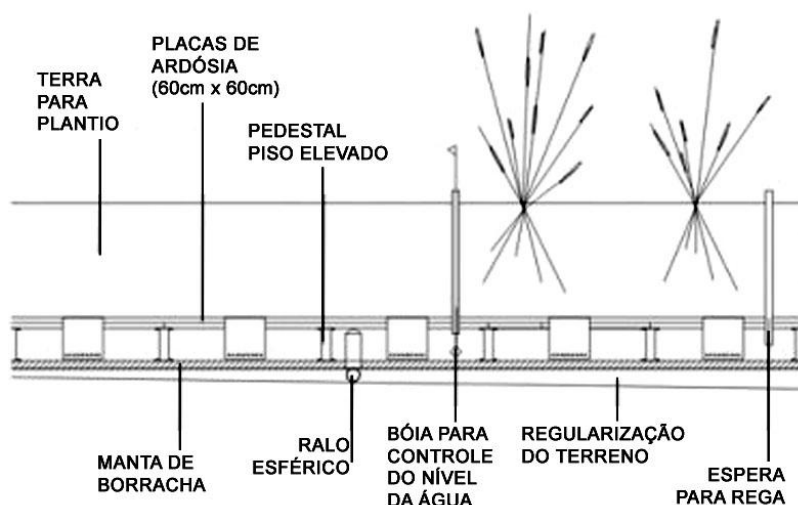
CORTE DO SISTEMA TECH-GARDEN
